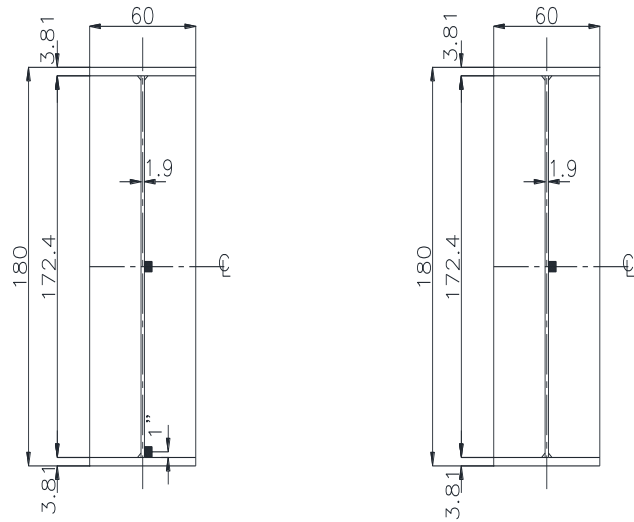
Ubicación de strain gage en la sección transversal de viga V-19.
